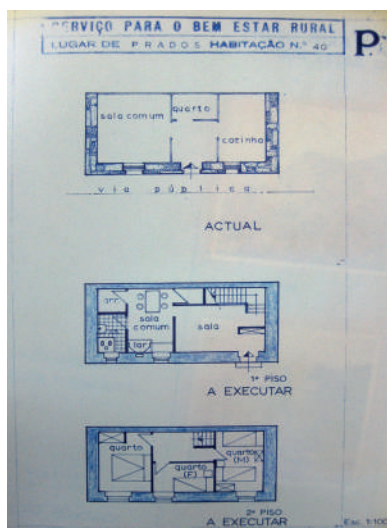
Prados, Habitação n.º 40: plantas da situação existente e da proposta a executar (JCI, 1963-65)
